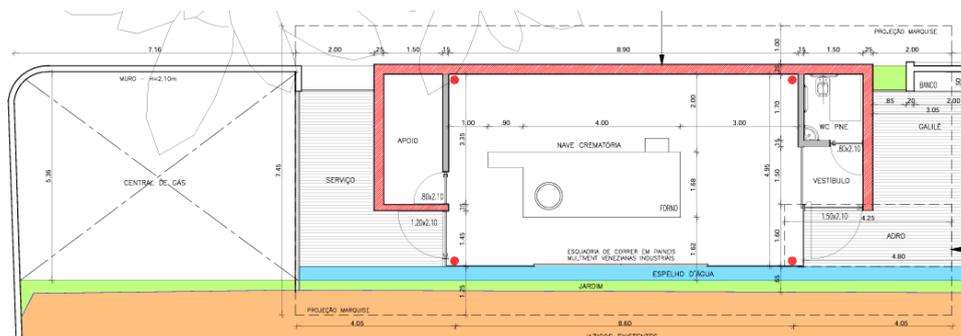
Planta baixa dos equipamentos a serem instalados. Fonte: proposta dos arquitetos Luiz Amorim e Roberto Lins
